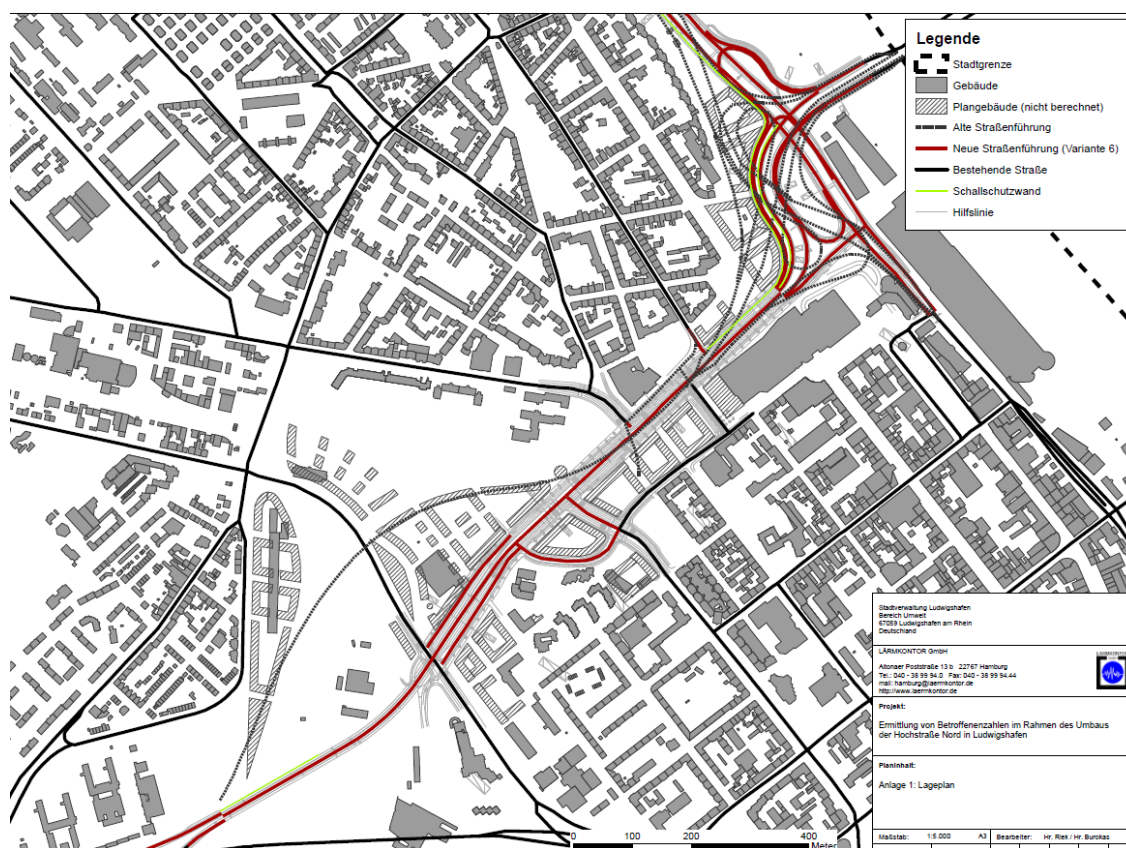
Geplante Trassenführung neue Stadtstraße
